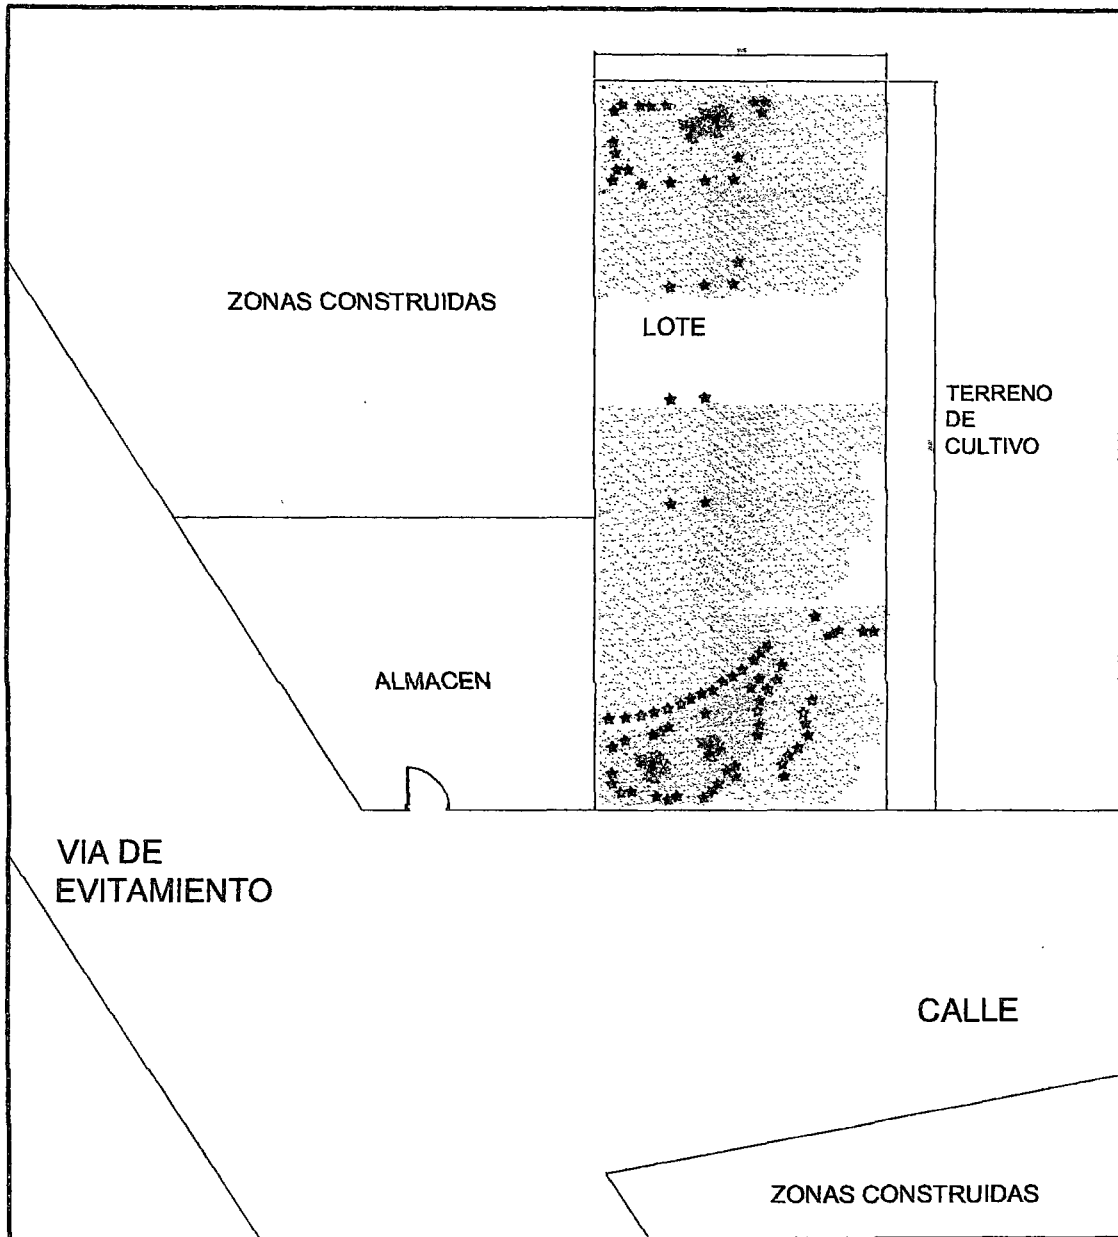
Ubicación y disposición de la zona de trabajo
